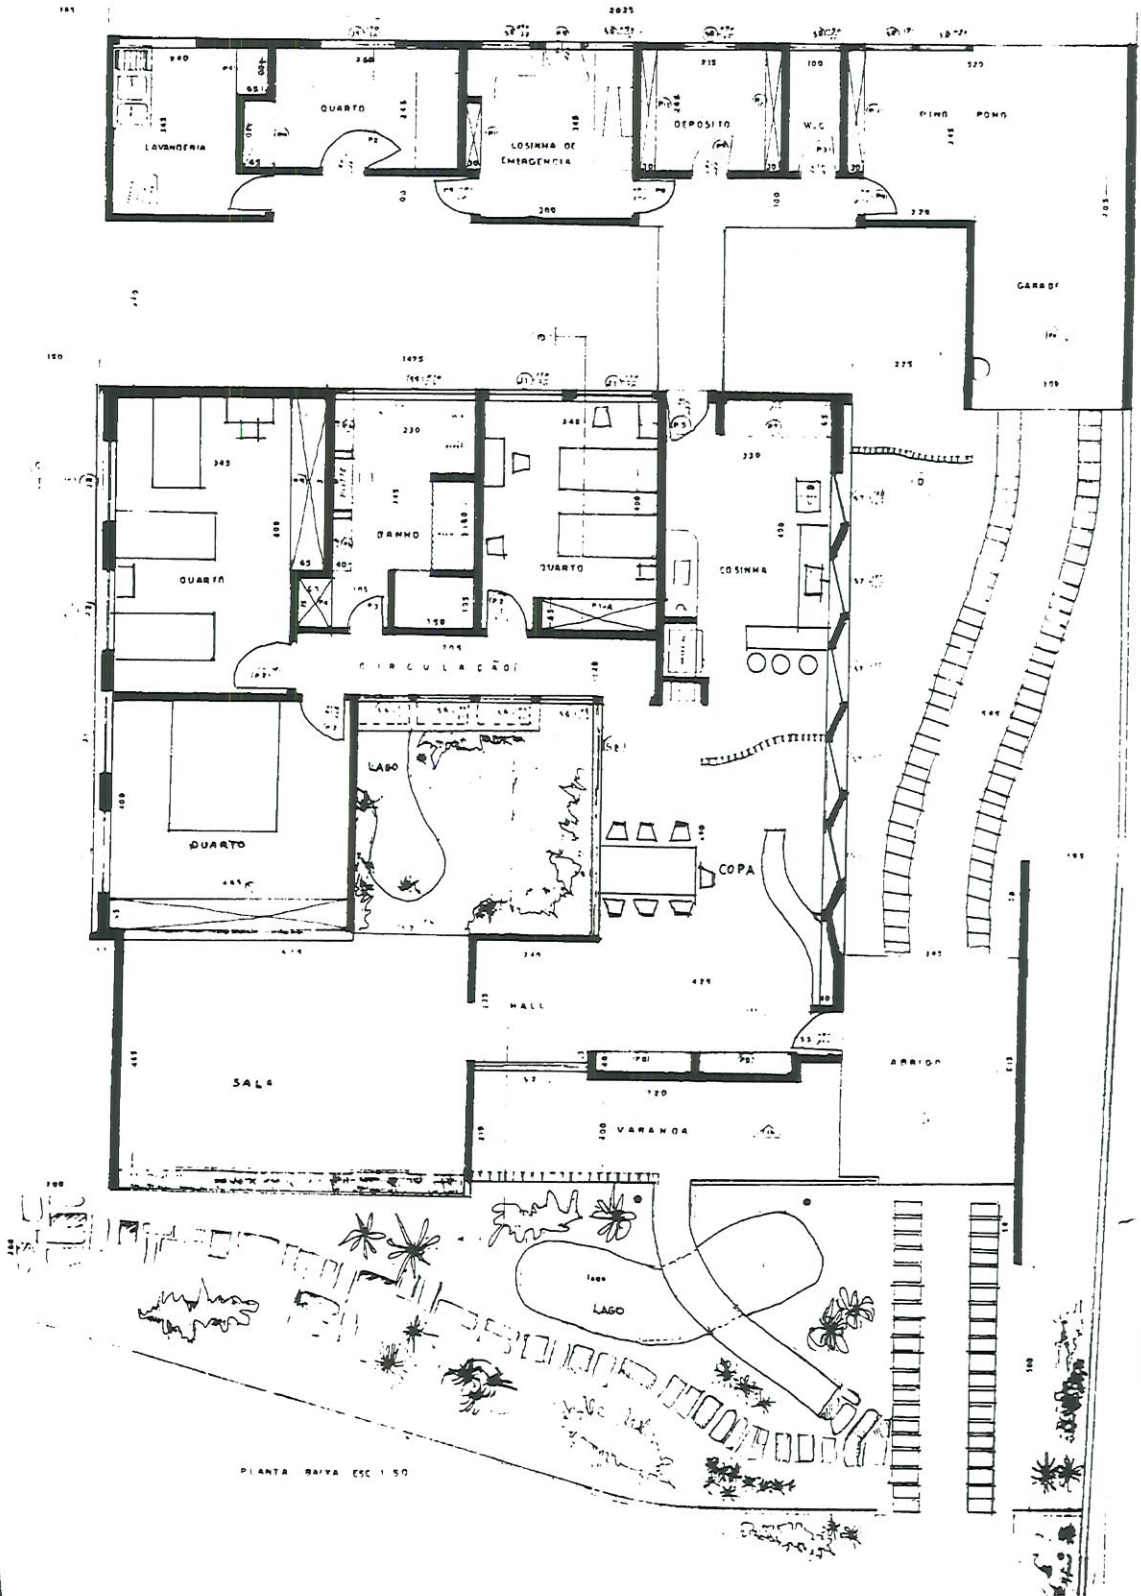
Residência Waldemar Silva – 1957 – Planta
